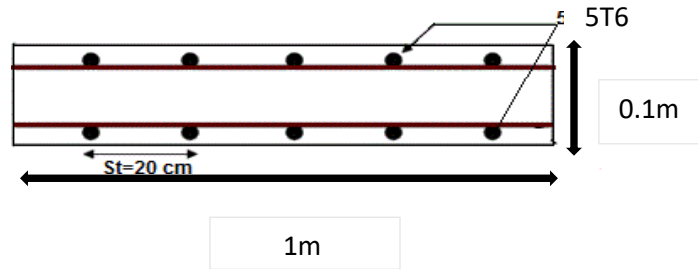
schéma de ferrailage de l'acrotère longitudinal.
